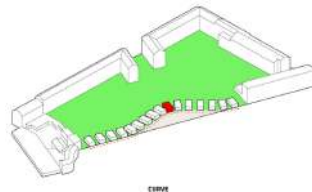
Vistas y Fachadas Residencia Dortheavej
